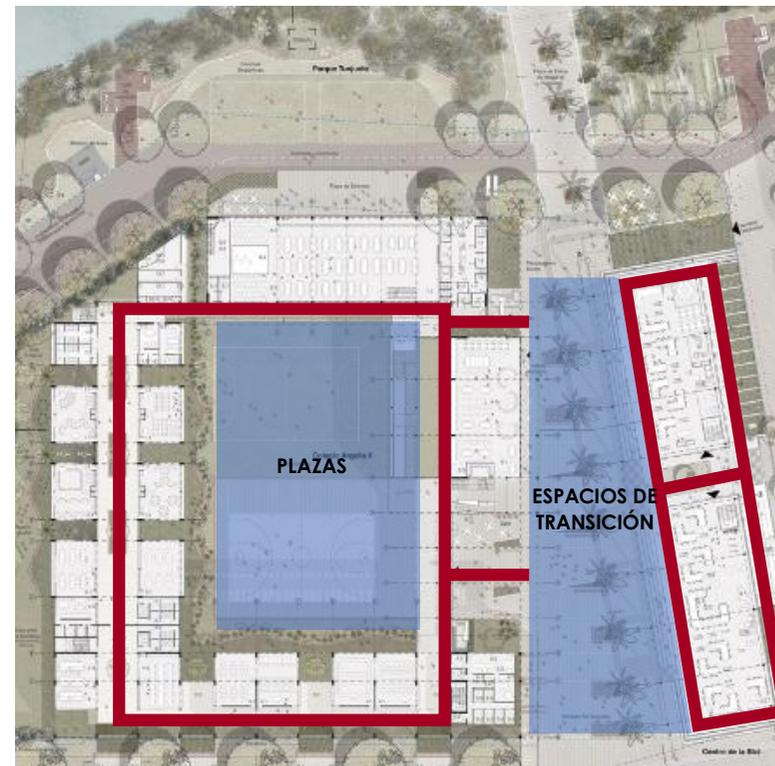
Planta de Distribución General de la propuesta. Fuente: Arch Daily Perú, 2017
